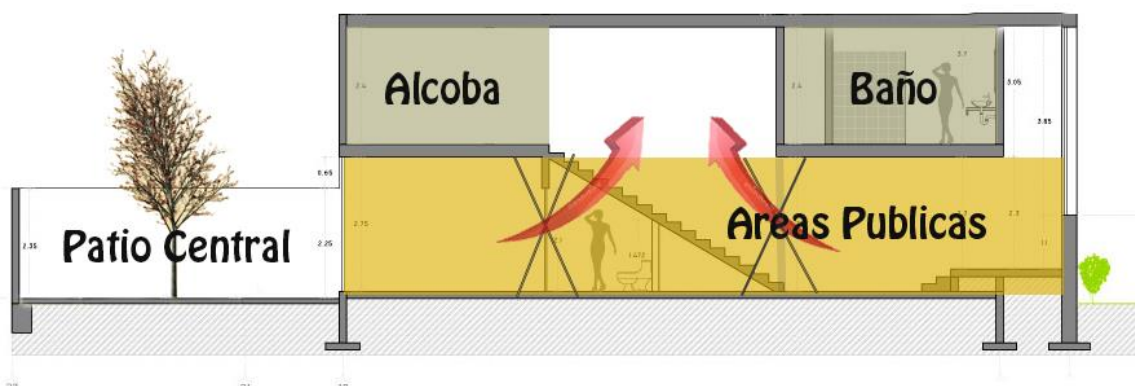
Corte por fachada representando dobles alturas. BJB | Elaboración propia 2014
